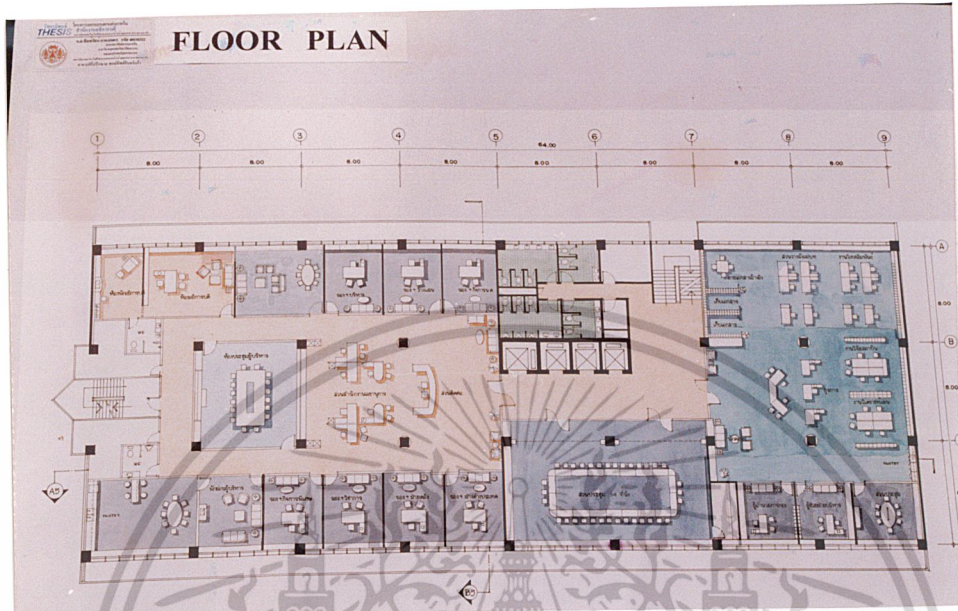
แสดง PLAN SKETCH ส่วนสำนักงานชั้นที่ 5
